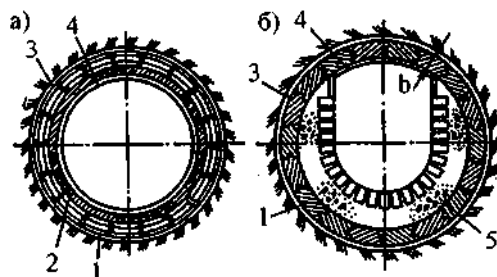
Коллекторы, выполняемые при закрытом способе строительства: а - круглой формы; б - полукруглой формы с облицовкой кирпичом; 1 - керамические или бетонные блоки; 2 - железобетонная рубашка; 3 - цементный раствор, нагнетаемый за блоки; 4 - штукатурка с железнением поверхности; 5 - бетон
